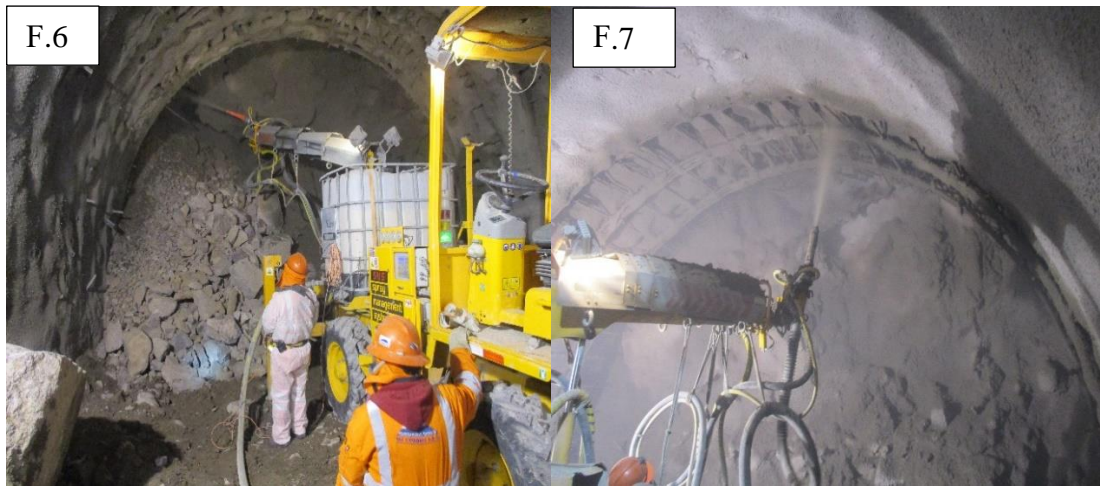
Gunitado de shotcrete preventivo sin fibra
